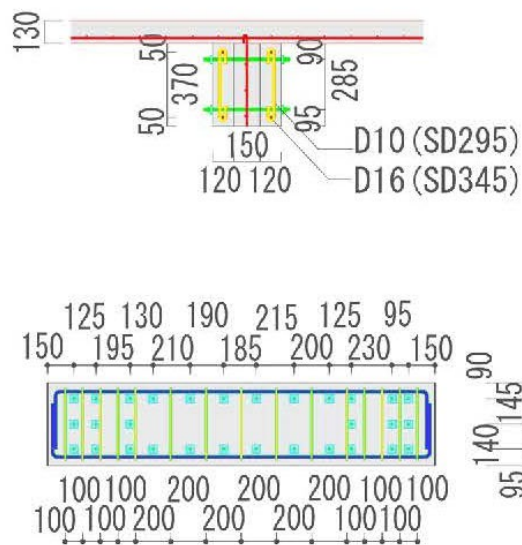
あと施工アンカー工事の工程図 施工完了，各部の寸法
